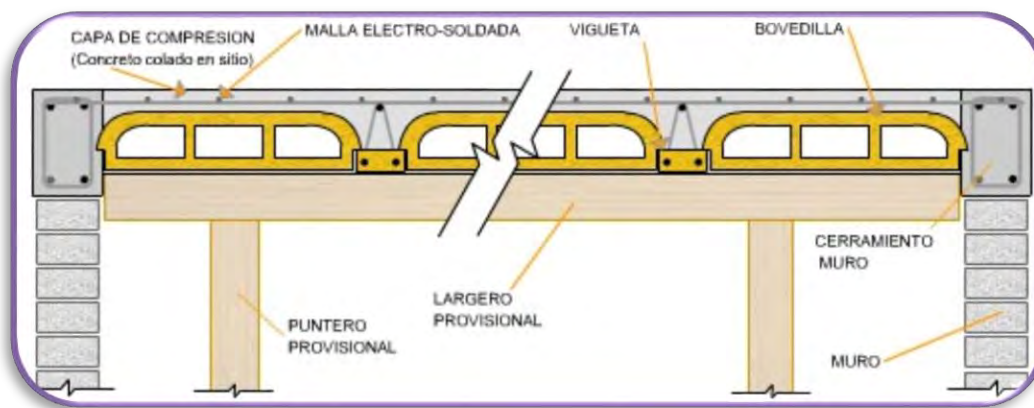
Detalle de Losa de Vigueta y Bovedilla
